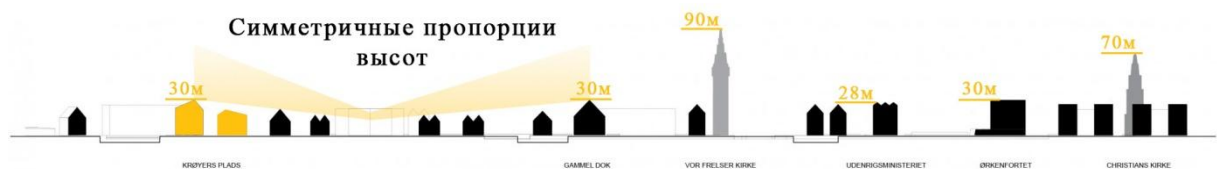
Формирование «морского фасада» нового жилого комплекса в русле устойчивой архитектуры. Авторская разработка на базе [10]
